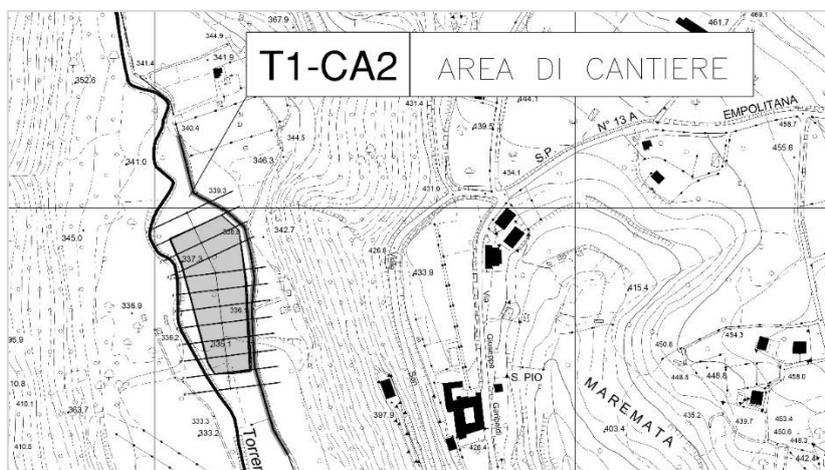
Inquadramento Planimetrico cantiere T1-CA2.
